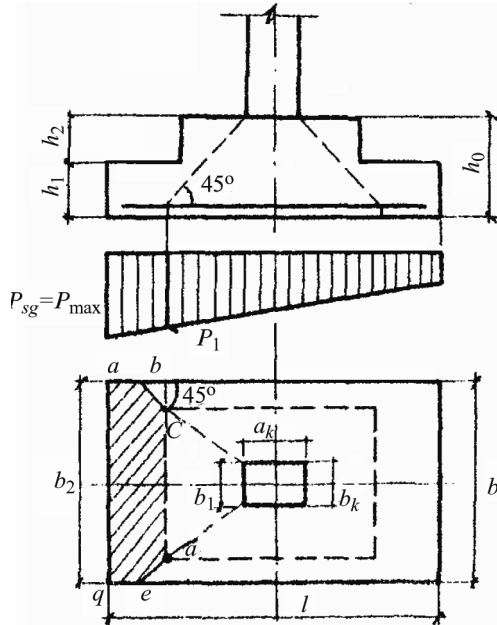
Схема до розрахунку фундаменту на продавлення
